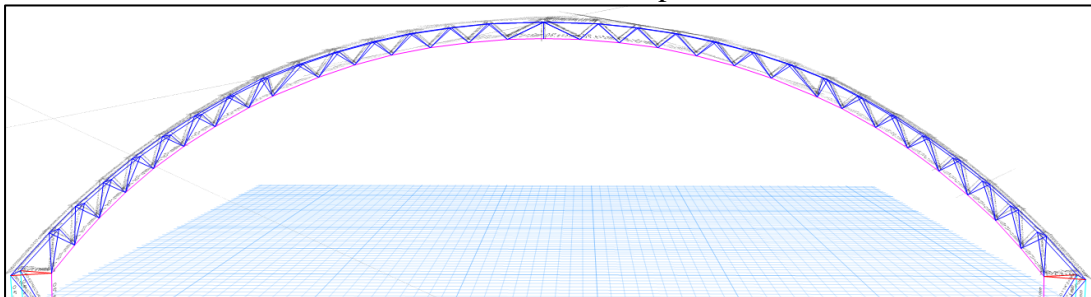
Vista frontal de los pórticos de la estructura.
